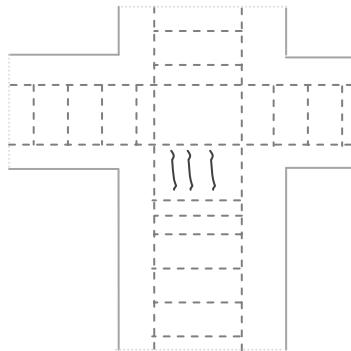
Esquema de fissura: cas del desplaçament de cercols en un pilar.
